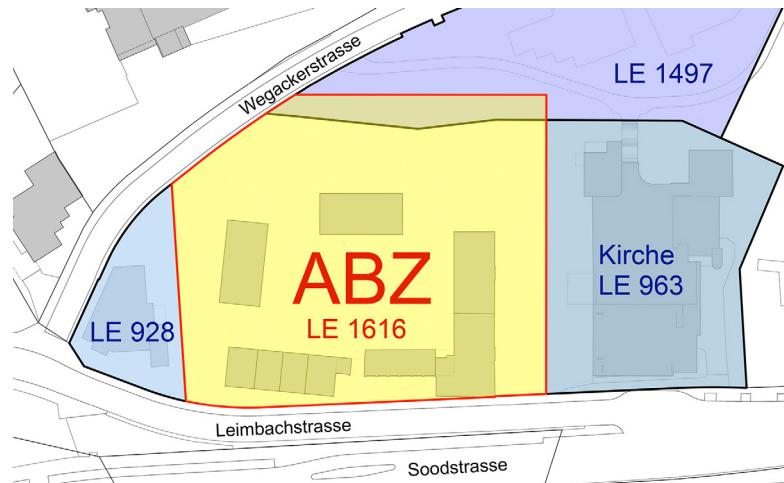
Situationsplan, Siedlung Leimbach (LE 1616) mit Nachbarparzellen
